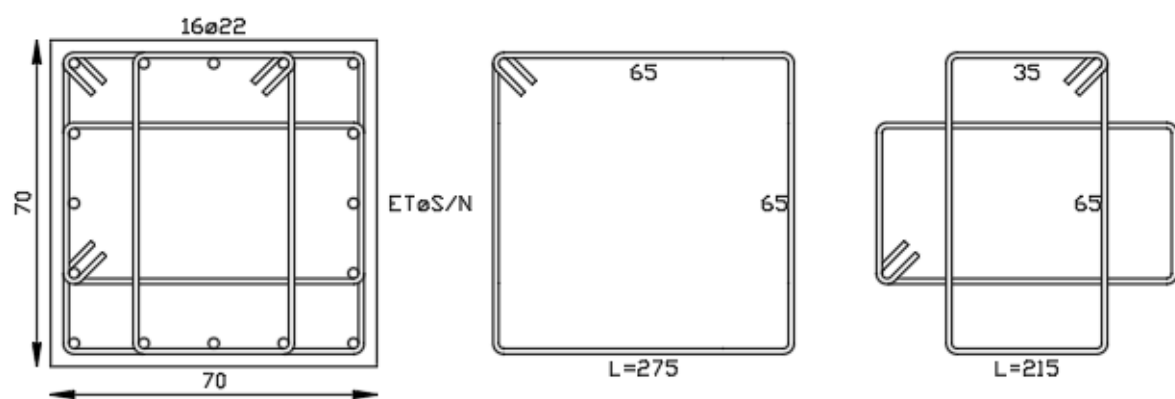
Columnas C02, Edificio 15 pisos.
